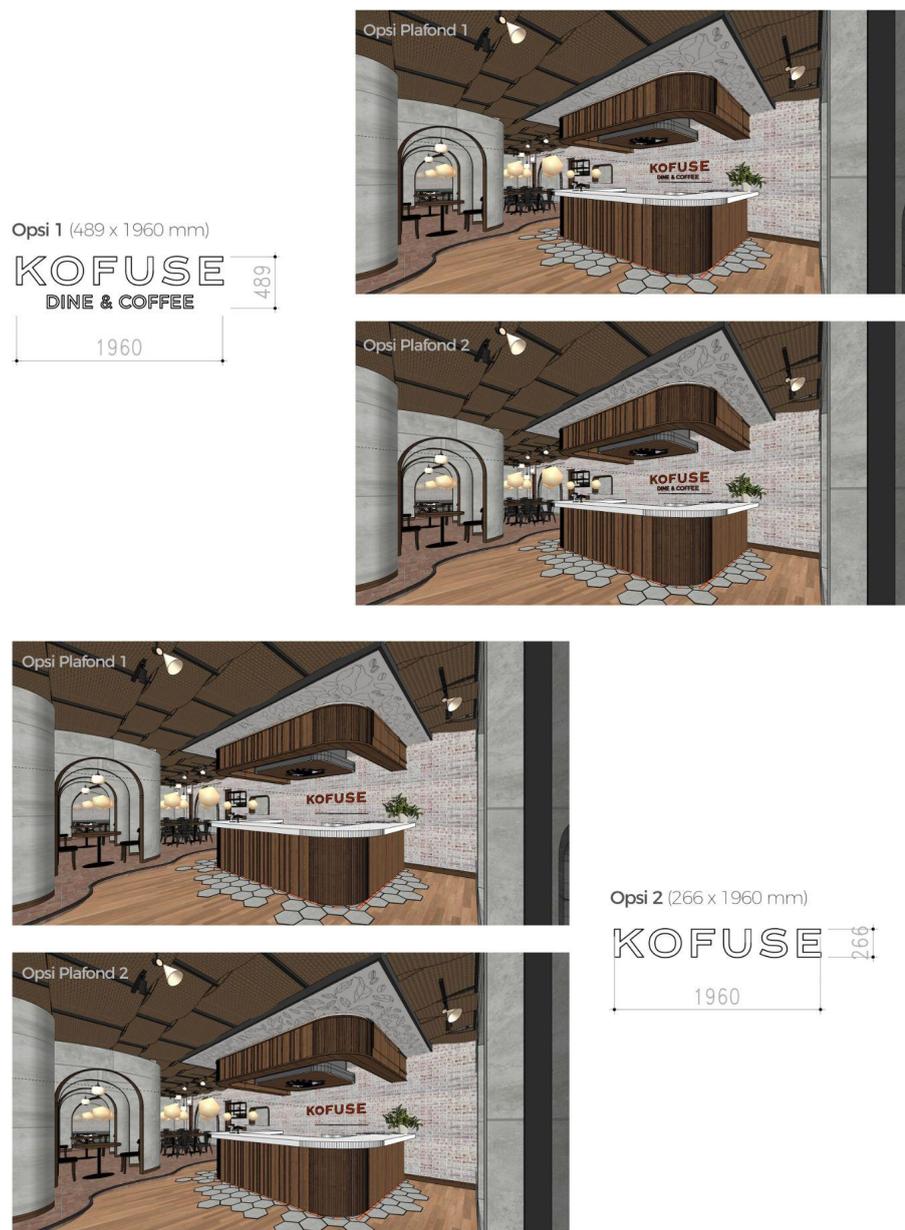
Alternatif Desain Stiker Plafon
